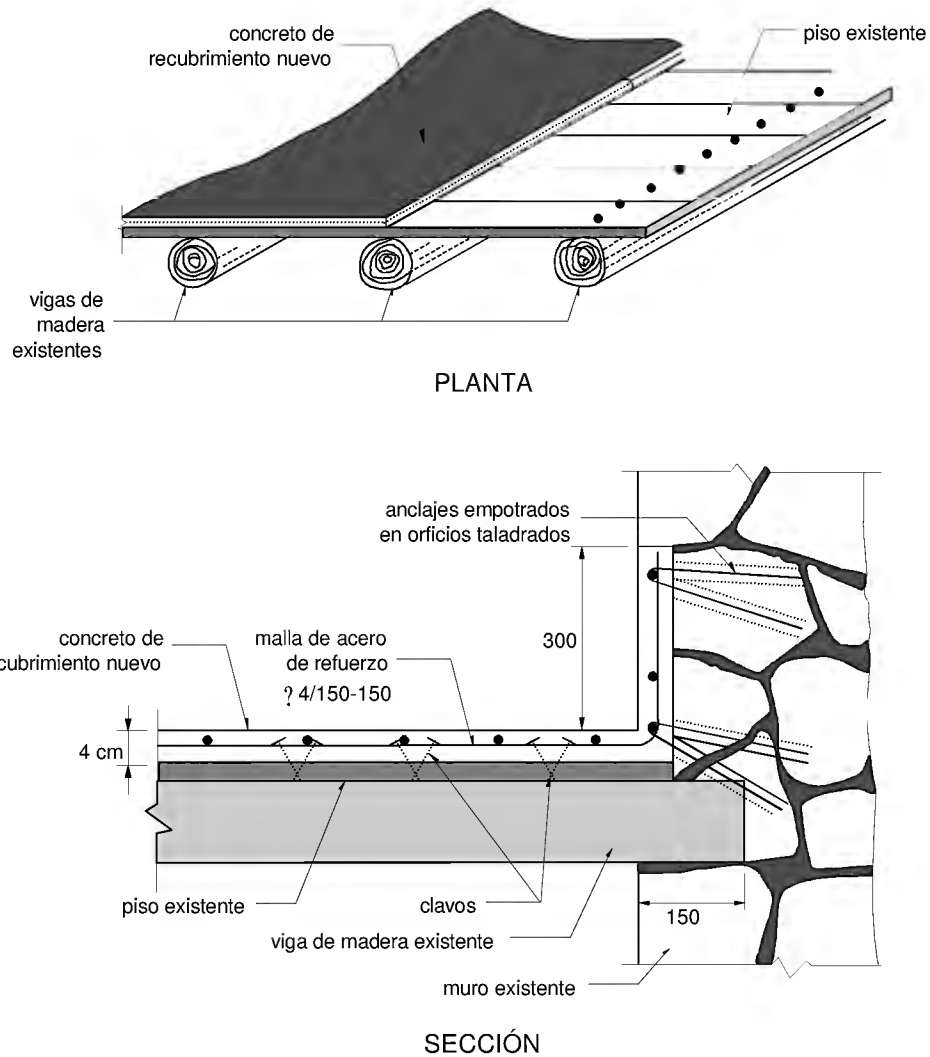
Refuerzo de un sistema de piso de madera adicionando una losa de concreto de espesor delgado
